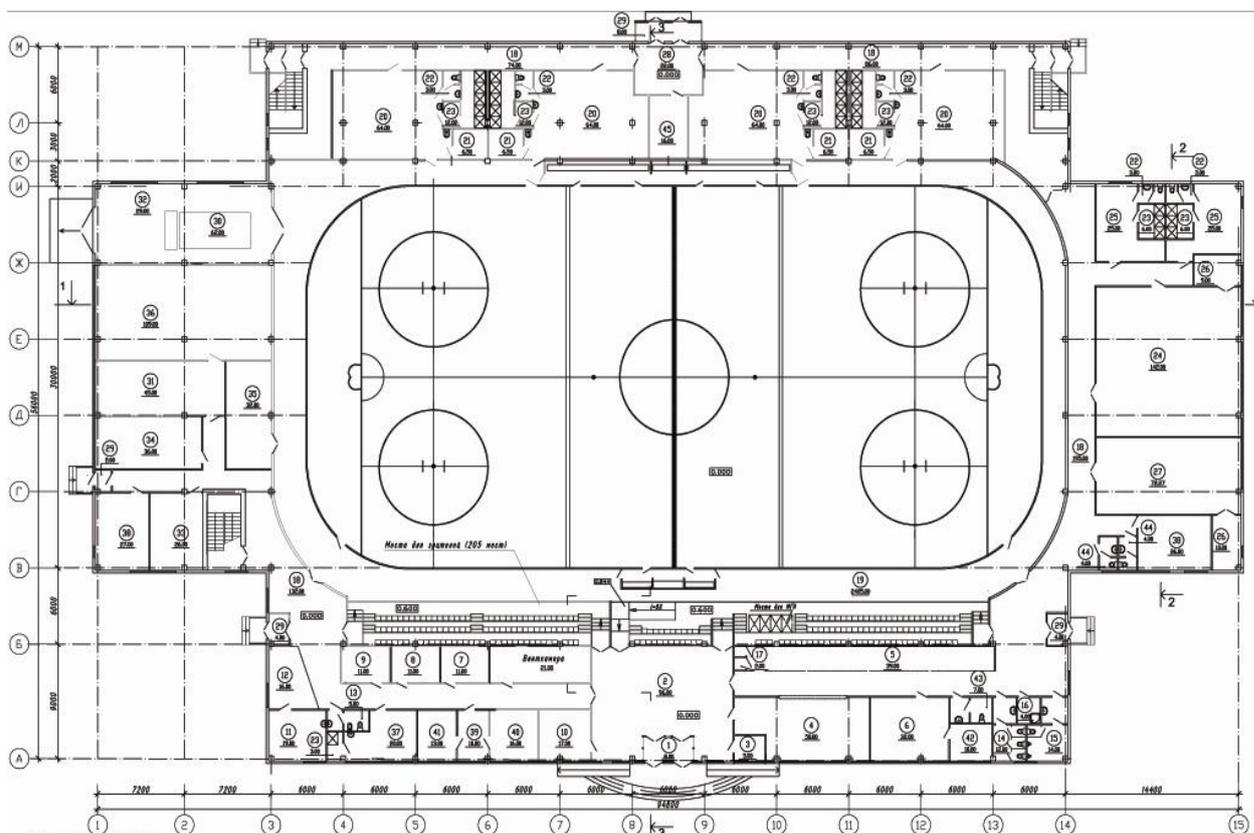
Пример планировки тренировочного катка для хоккея с шайбой
